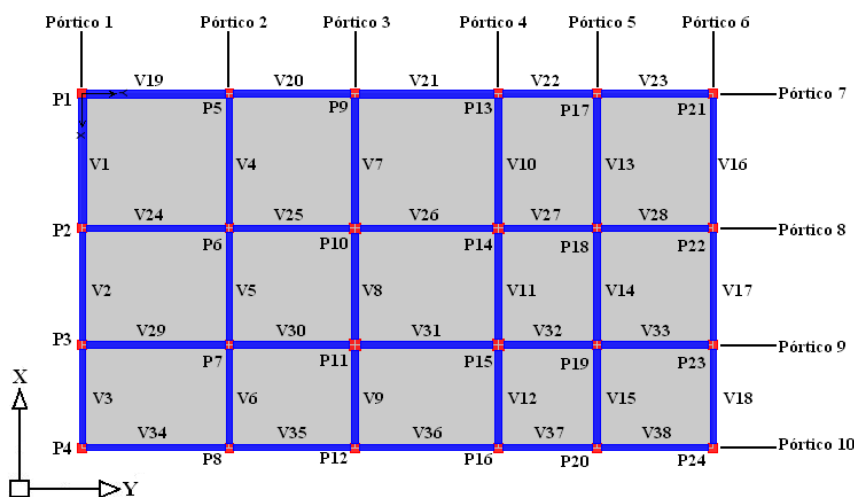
Vista em planta da estrutura sem irregularidades em sua forma com os elementos numerados.
